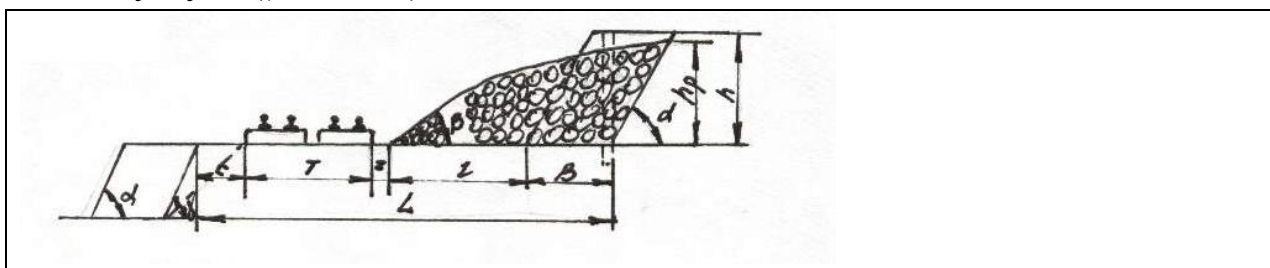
Схема к определению ширины рабочей площадки в скальных породах
